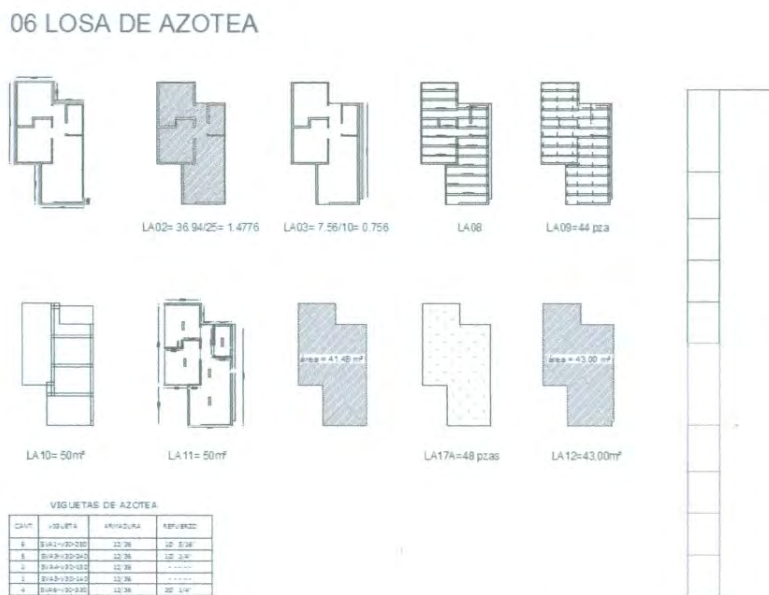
Plano de losa de azotea para cubicar las cantidades de insumos
